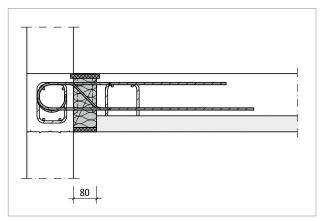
Schöck Rutherma® T type DF : distance minimale par rapport à la facade
